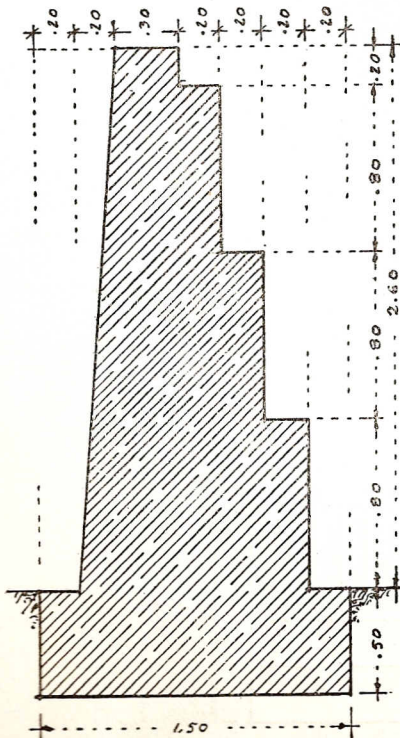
CORTE DE MURO DE SUPORTE COM JORRAMENTO
